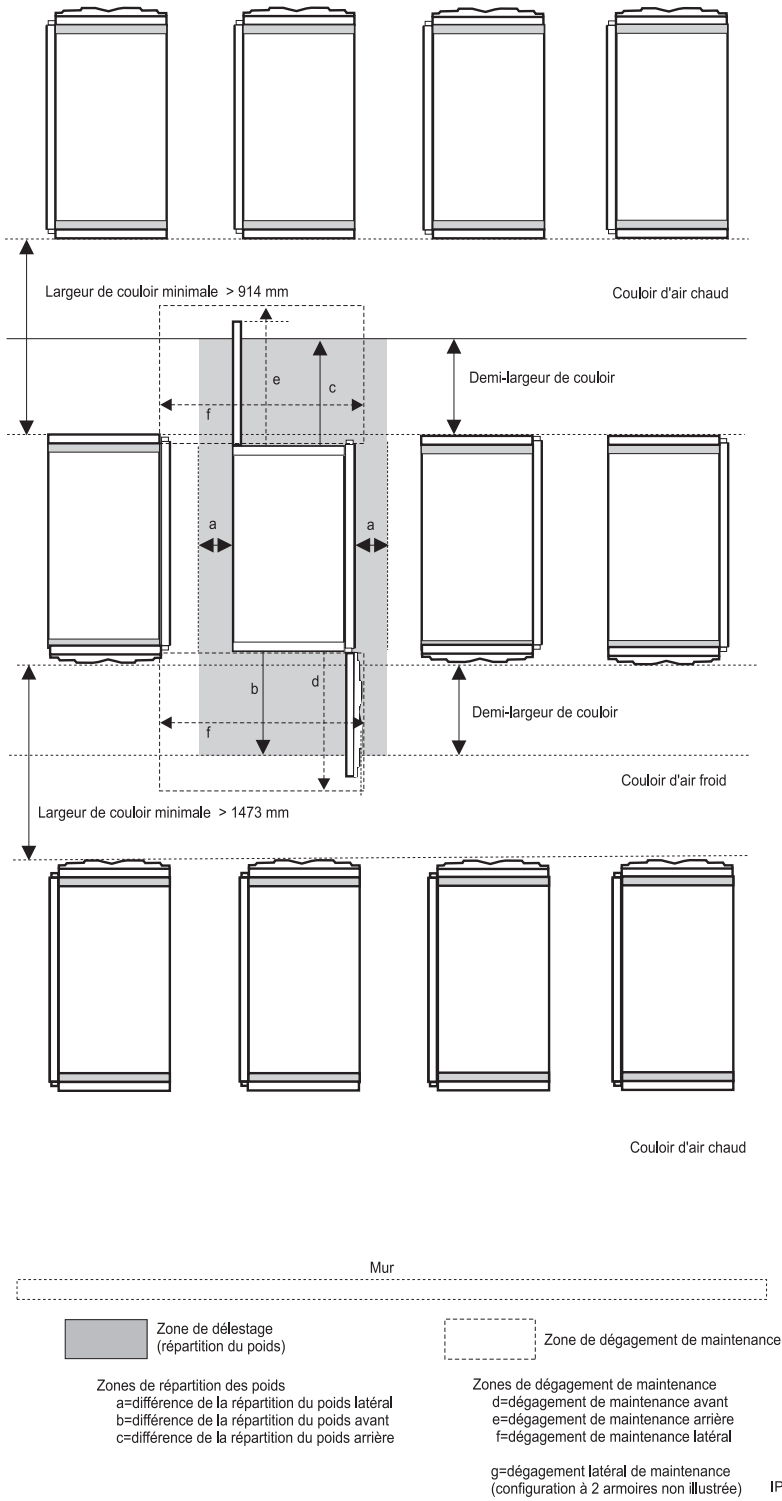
Disposition des dalles suggérée pour l'installation de plusieurs systèmes
